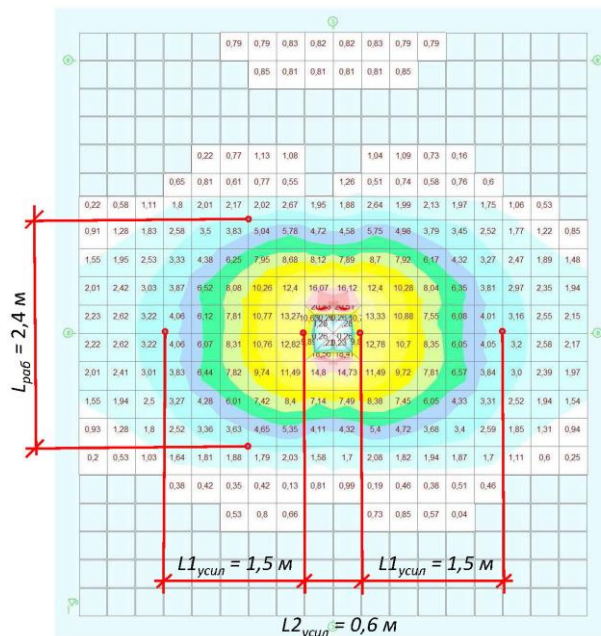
Пример определения размеров двух зон дополнительного верхнего армирования опорного участка перекрытия (арматура вдоль цифровых осей – вдоль местной оси Y1)
